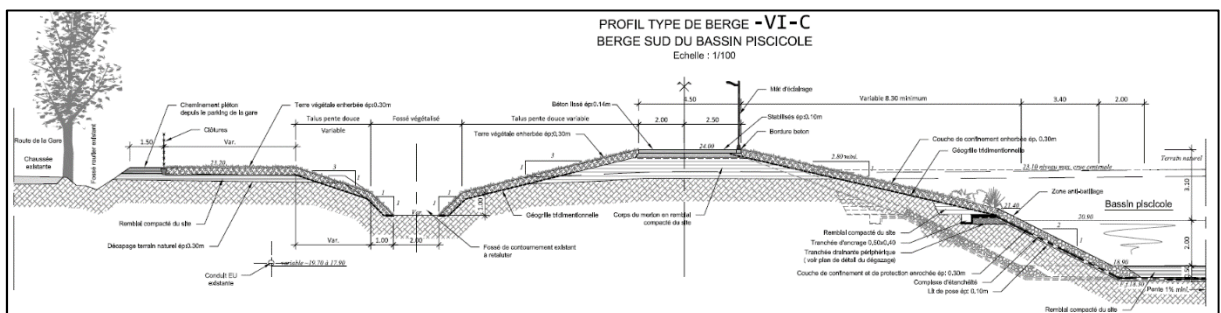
Profil en travers type de la berge situé au sud du bassin piscicole
